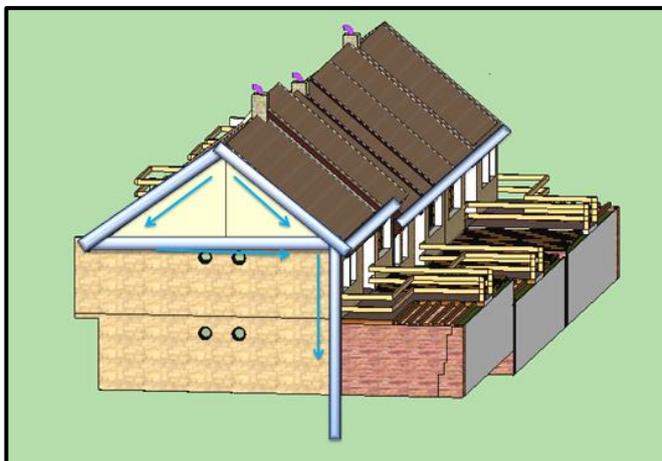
Principe de distribution de l'eau collecté à travers la toiture inclinée
